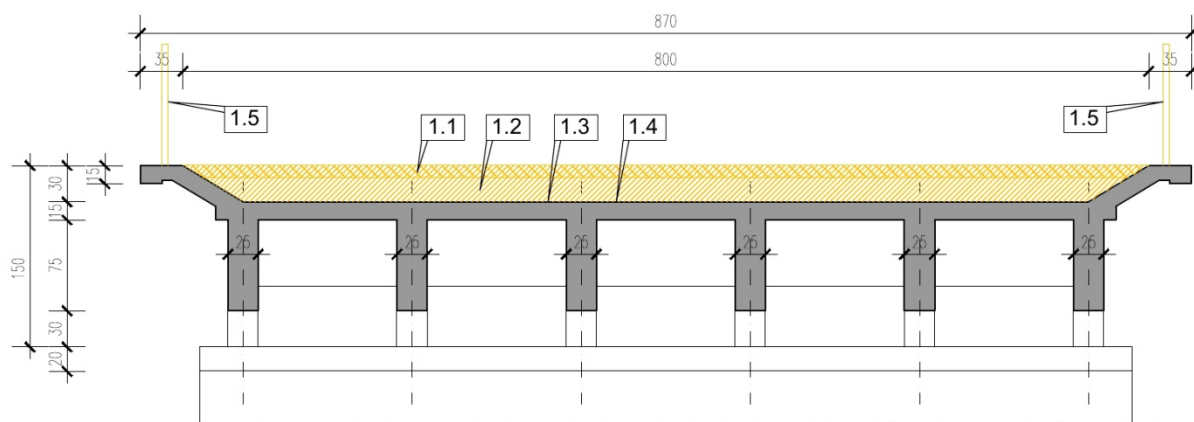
Sezione tipologica impalcato - fase di demolizione
